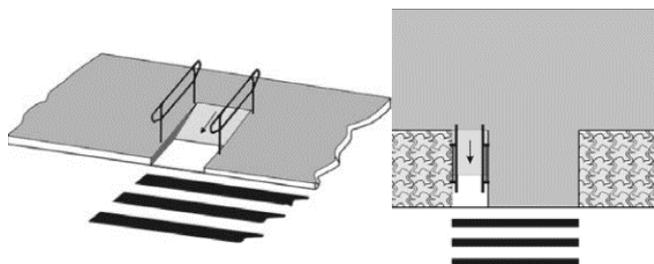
Вариант размещения пандусов на отнесенных пешеходных переходах, располагаемых на перегонах
